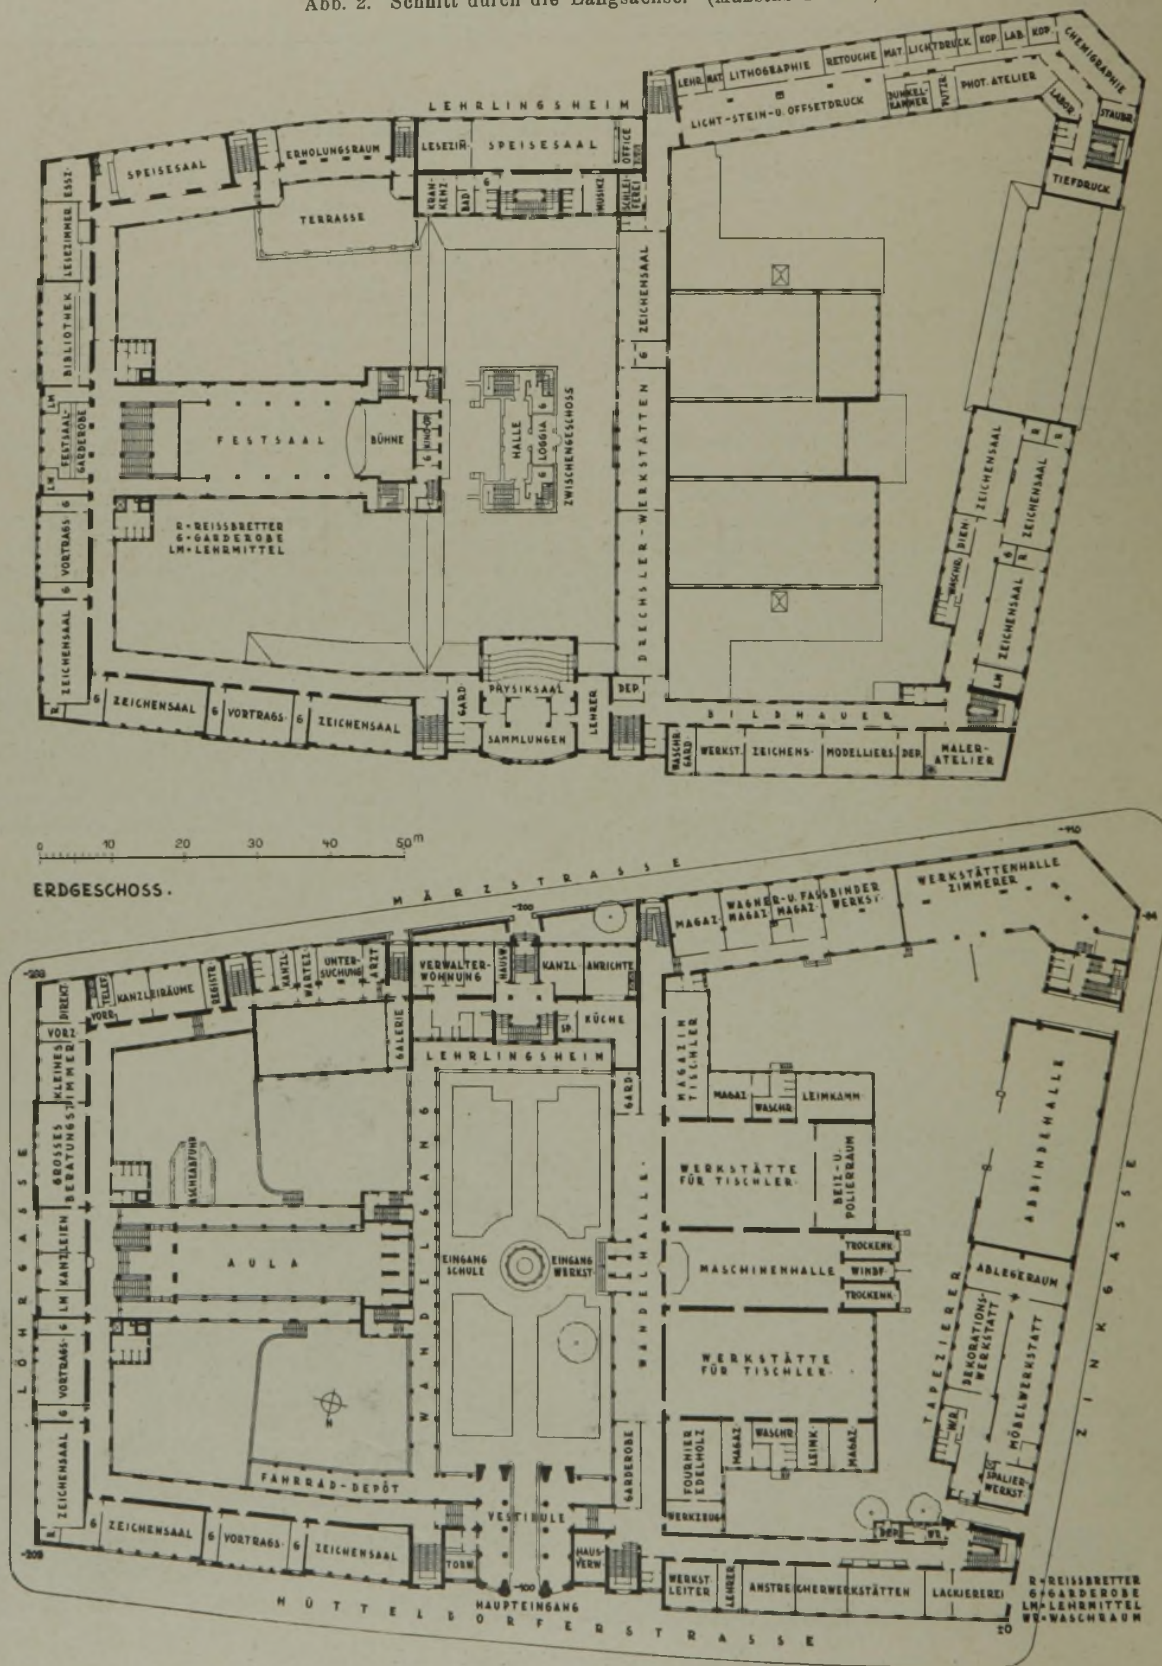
u. 4. Grundrisse vom Ober- und Erdgeschoß. (Maßstab 1:1000.)
